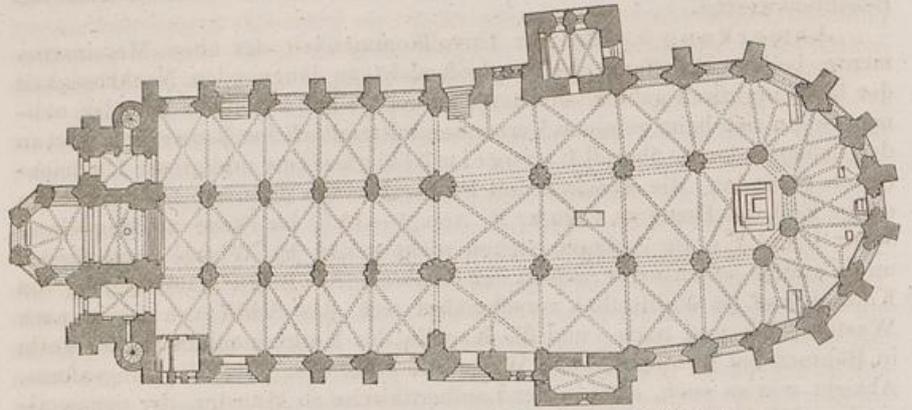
Grundriss der Sebaldskirche in Nürnberg (nach Heideloff).
